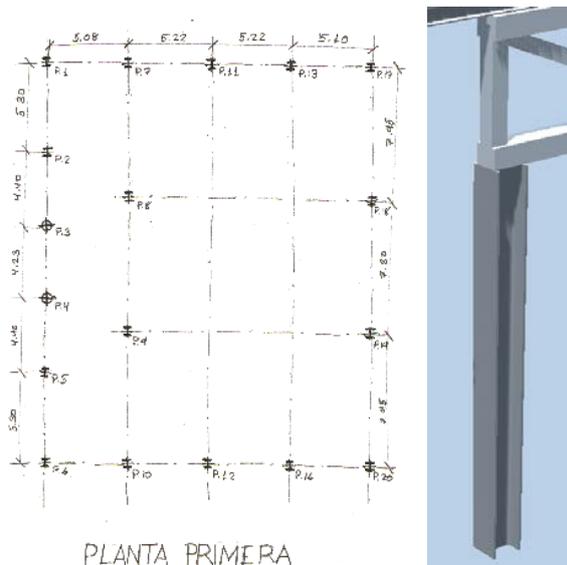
Croquis de distribución de pilares en Planta Primera y animación de pilar tipo extraída del modelo, Allplan. (Elaboración propia)
